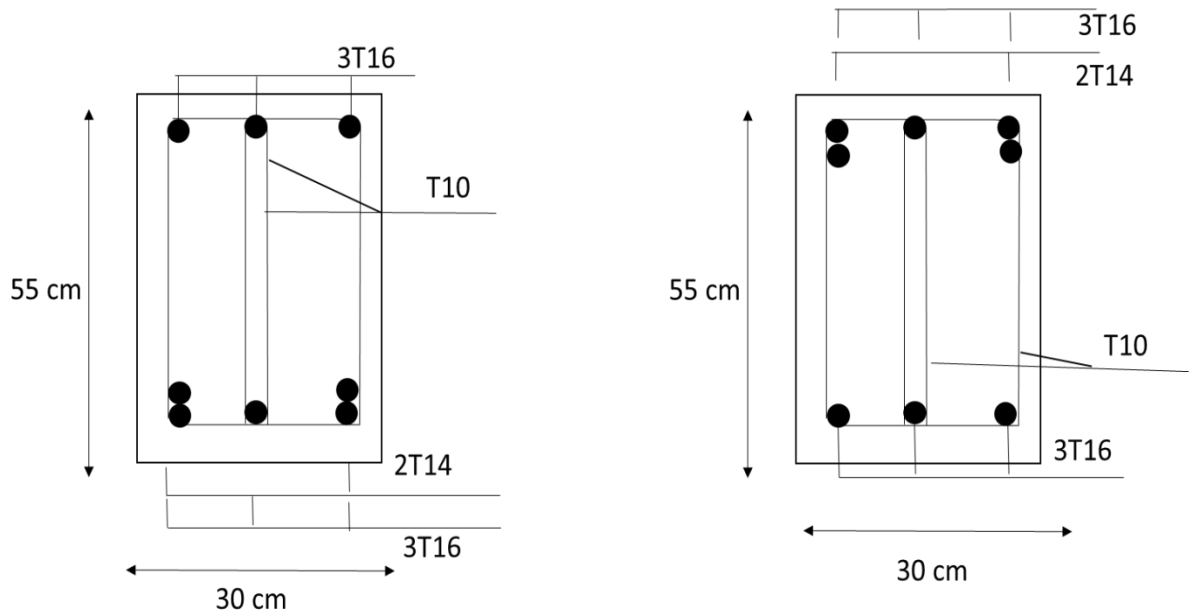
Schéma de ferraillage de poutre principale 30x55 (terrasse).
